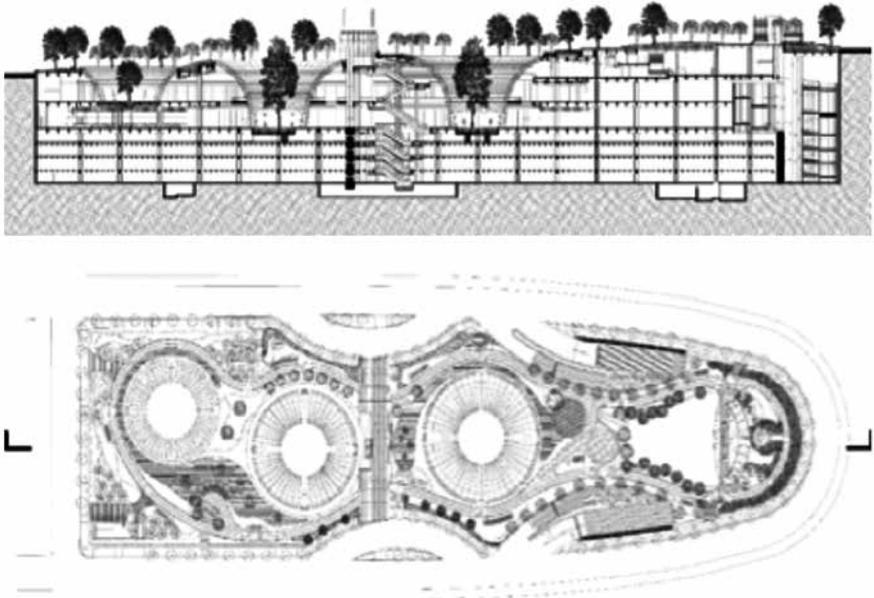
Planta y corte longitudinal del Centro Comercial Garden Santa Fe, en la Ciudad de México.
